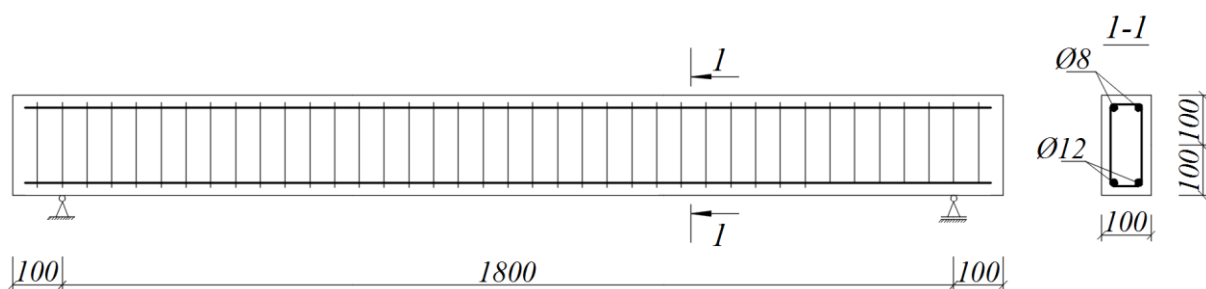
Армирование железобетонной и сталефибробетонных балок стержневой арматурой
